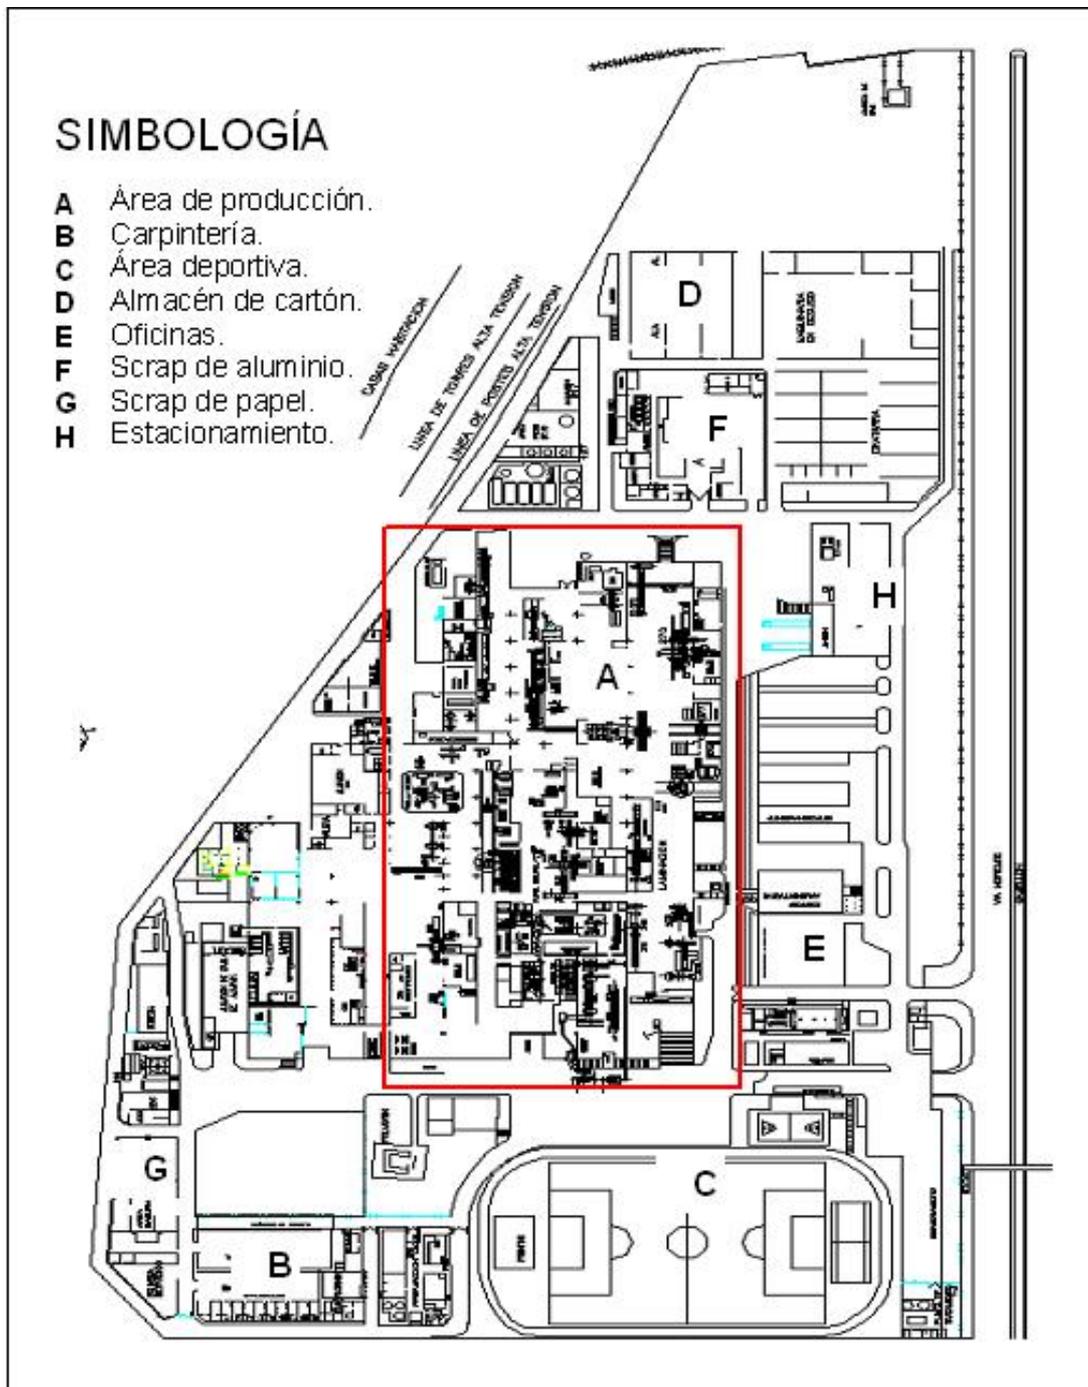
LAY OUT de Almexa Aluminio S.A. de C.V. Planta Tulpetlac.
